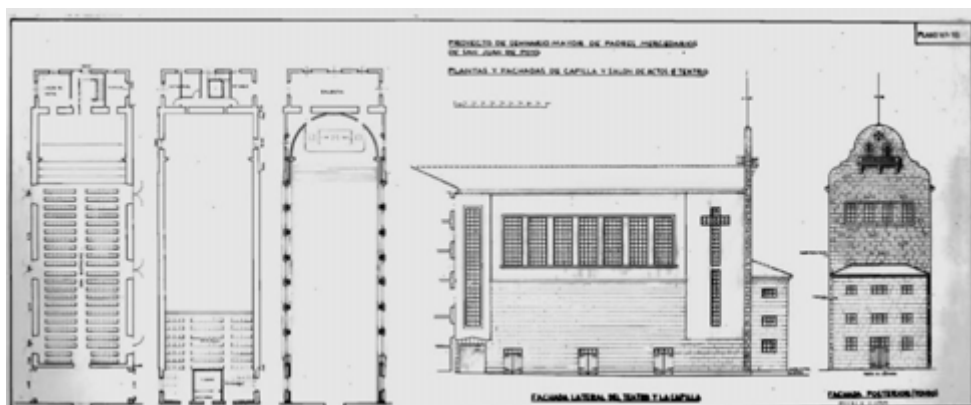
Plantas y fachadas del teatro y Capilla. Fuente: Archivo Provincial.
